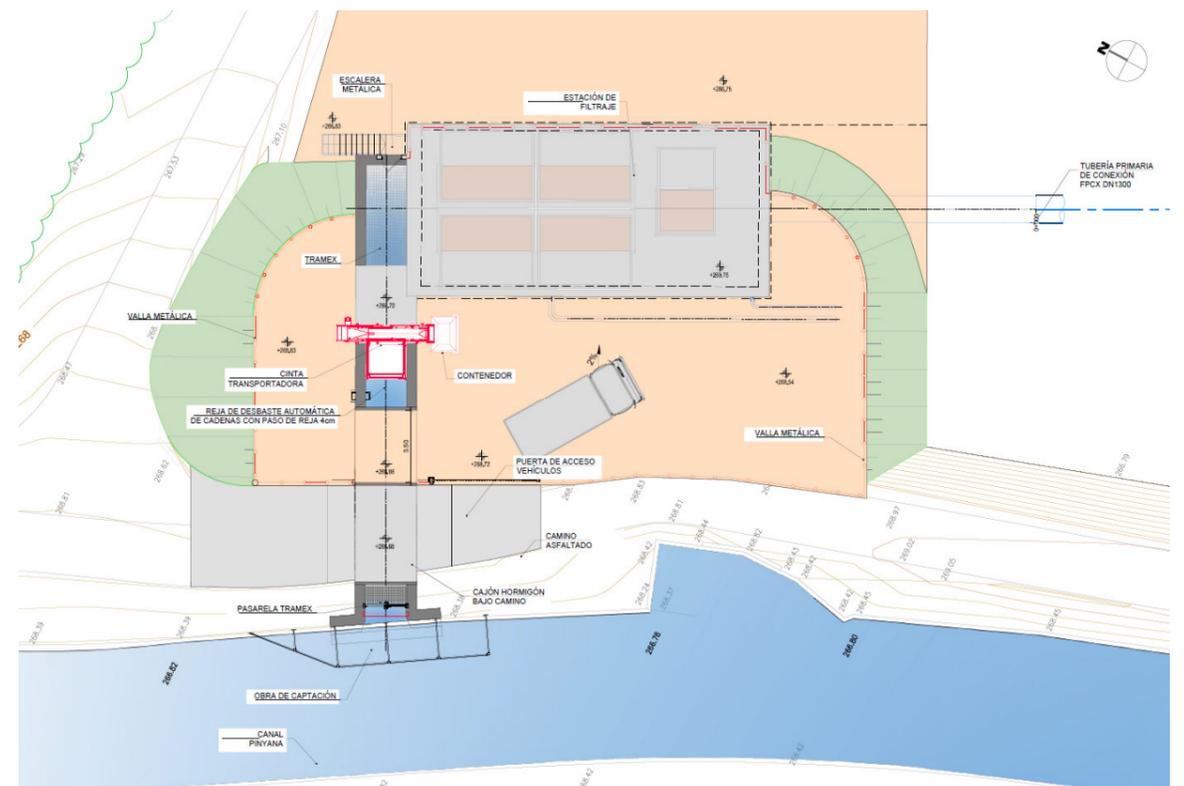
Planta general de la obra de captación y la estación de filtraje.
